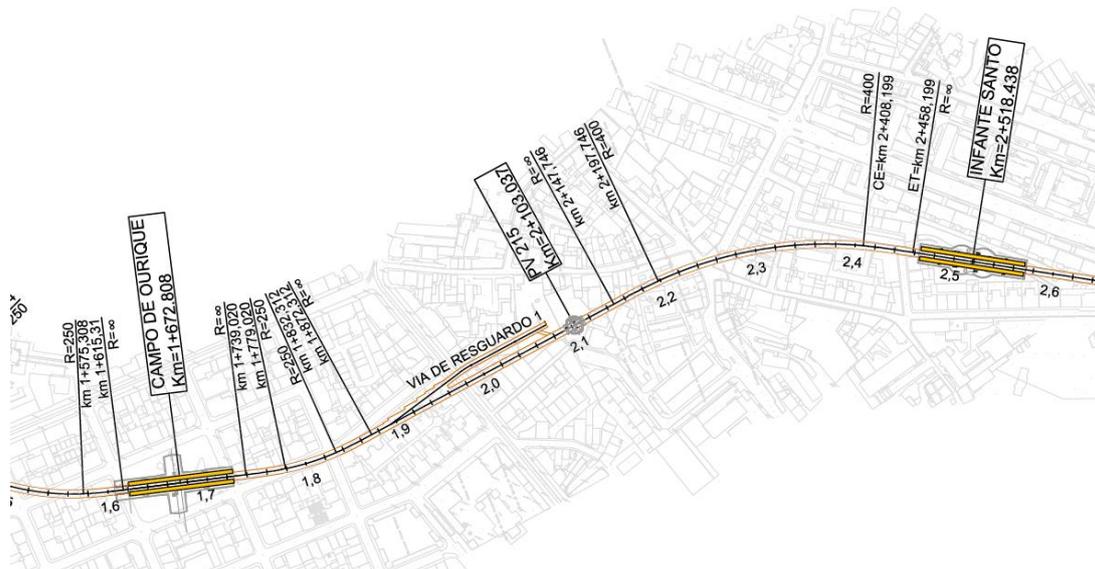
Traçado em Planta – 83.º Troço – Infante Santo – Campo de Ourique
